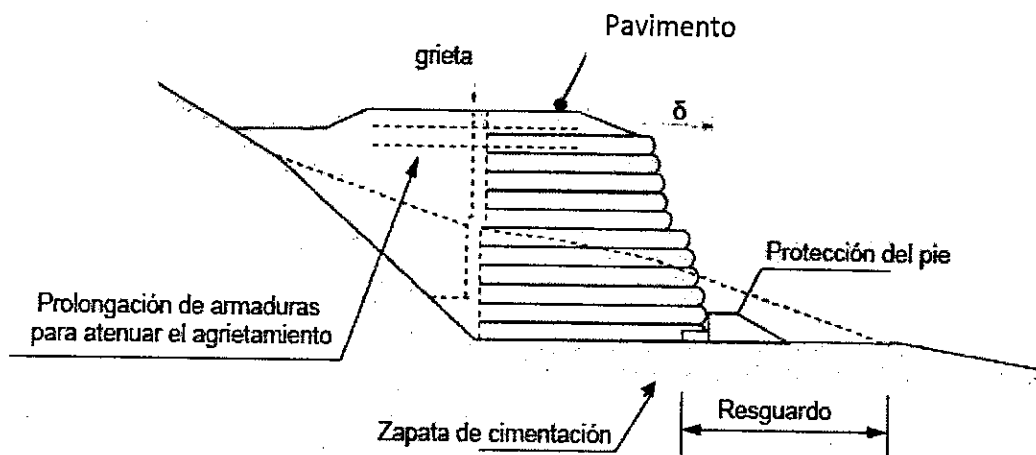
Agrietamiento de la superficie del pavimento en muros de tierra armada (MINFOMENTO, 2004)
